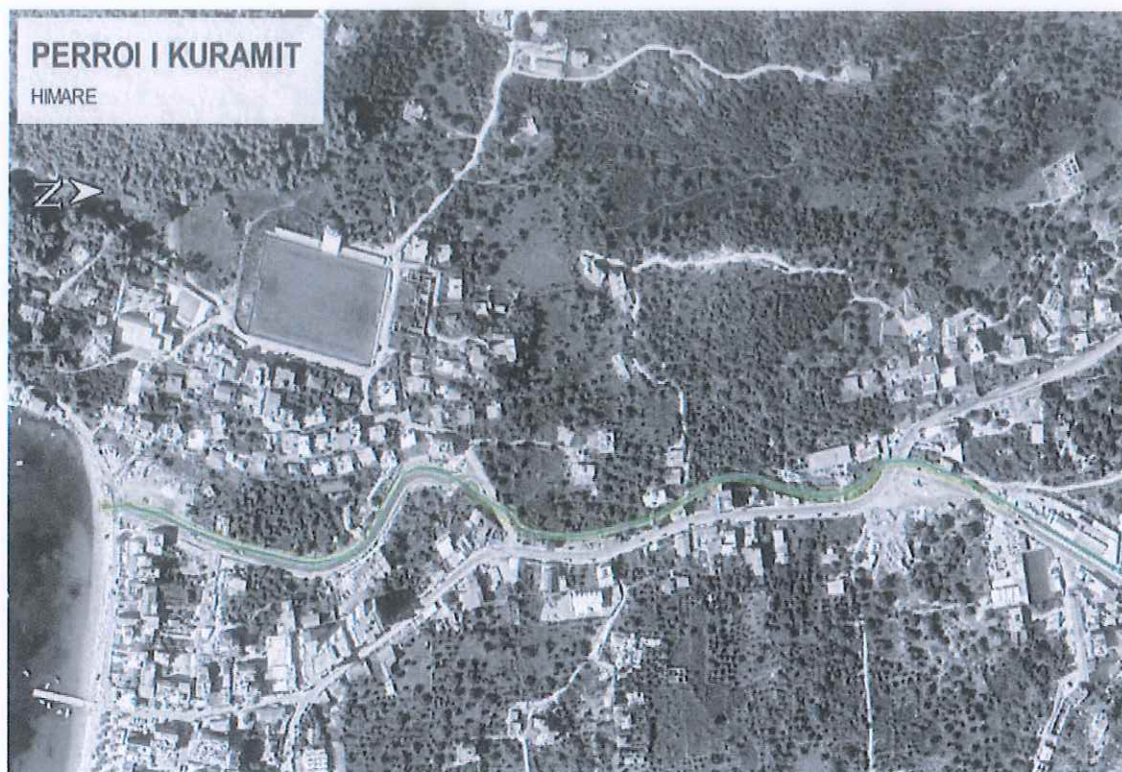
Planvendosja e Prroit, gjendja ekzistuese
